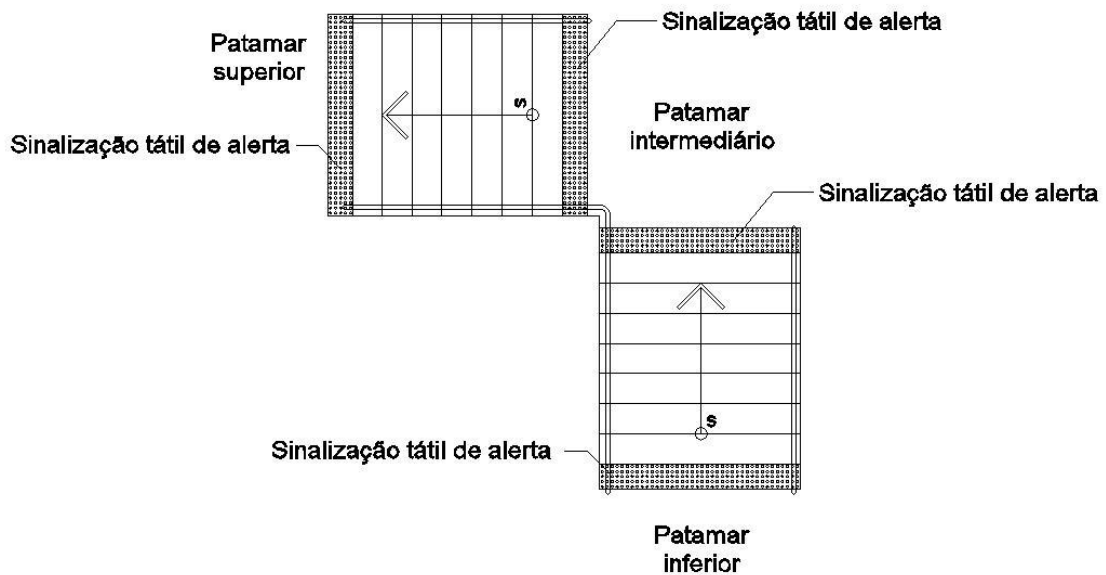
Patamar de escada ou rampa com circulação adjacente
